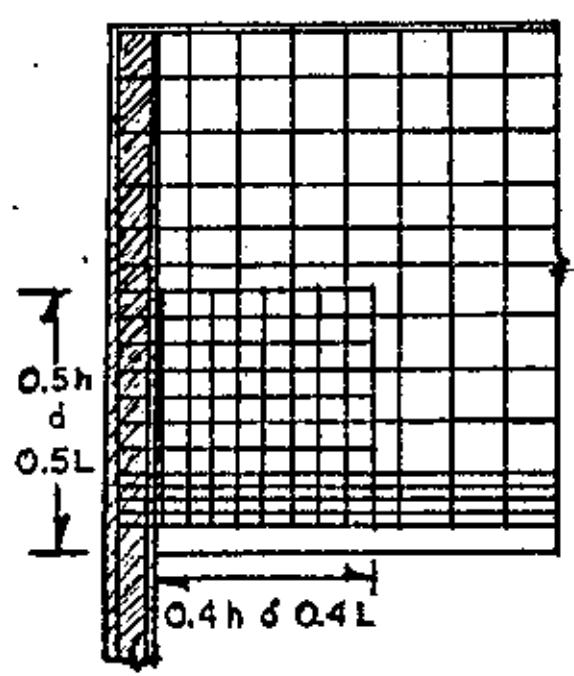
Refuerzo en una zona de apoyo indirecto
